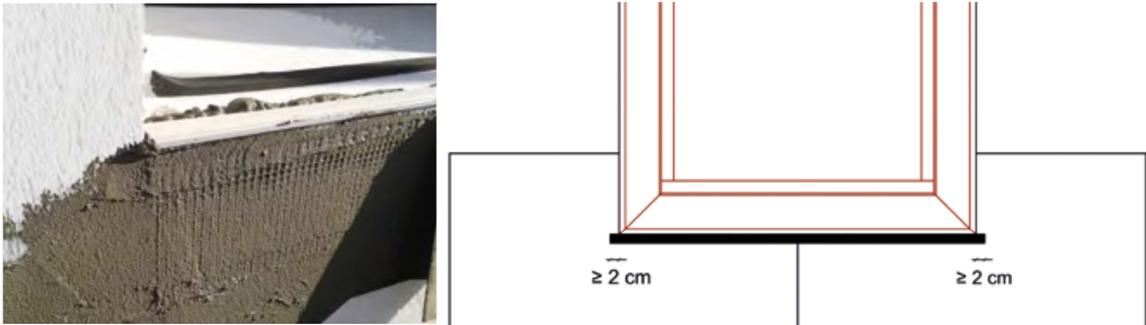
Colocación perfil de vierteaguas (izda). Esquema entrega vierteaguas con las jambas (dcha).
